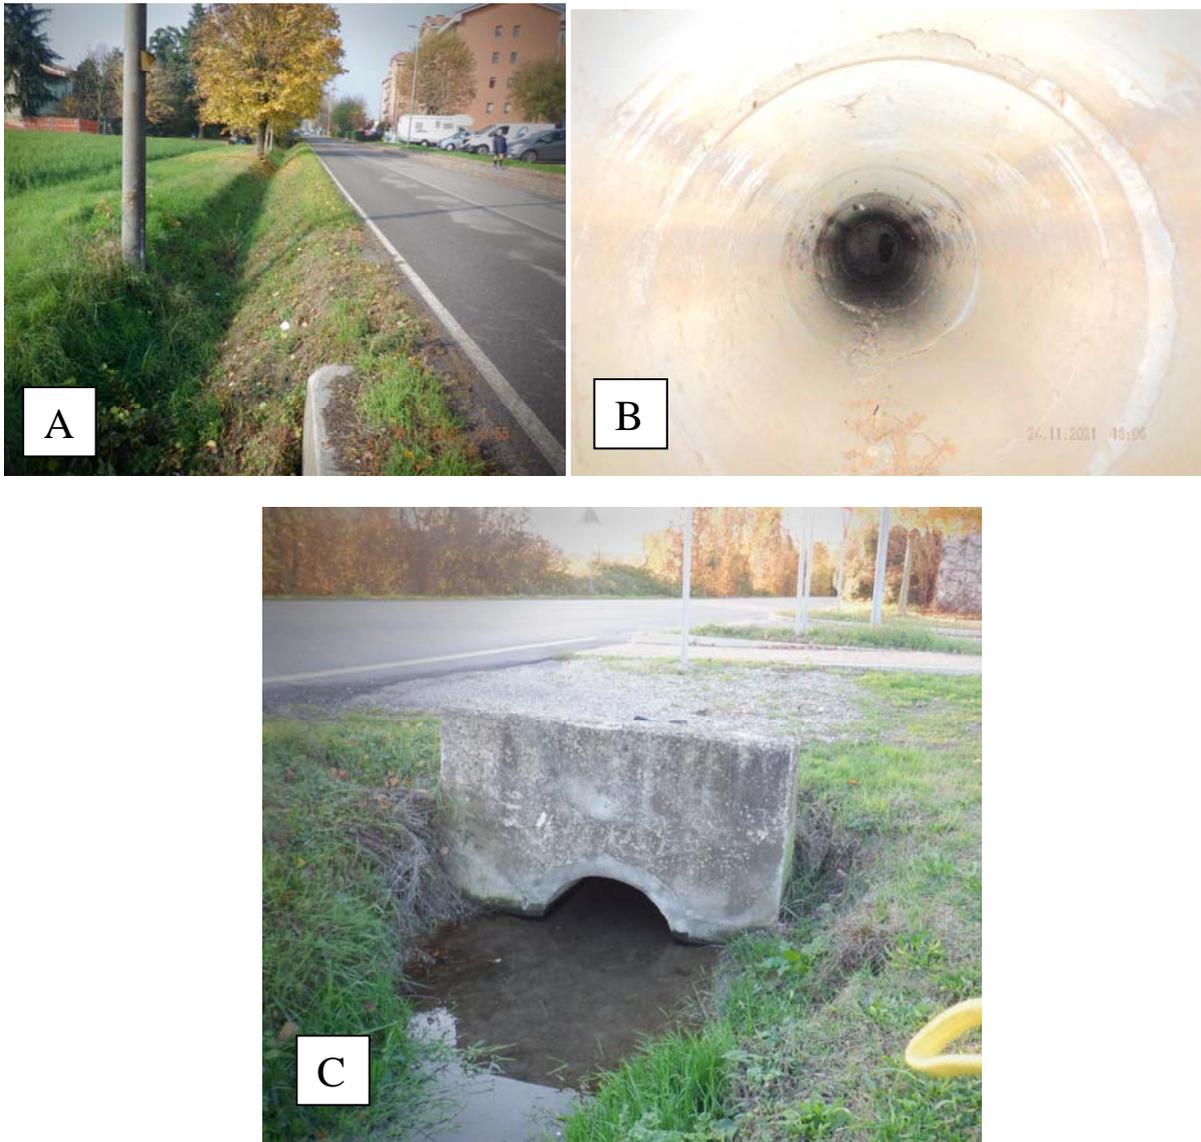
A) FOSSATO DI IMMISSIONE (IN PRIMO PIANO MANUFATTO ATTRAVERSAMENTO VIA TRE PONTI)
